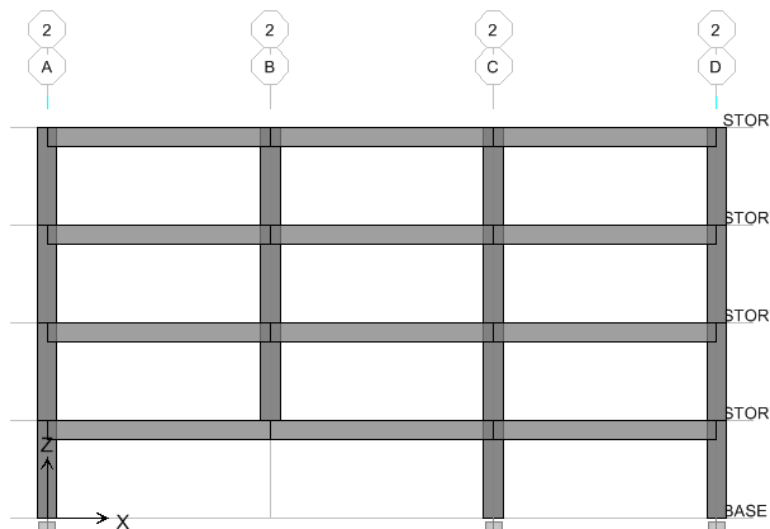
DEFORMADA EJE 2 CARGA MUERTA (Irregular en elevación).
